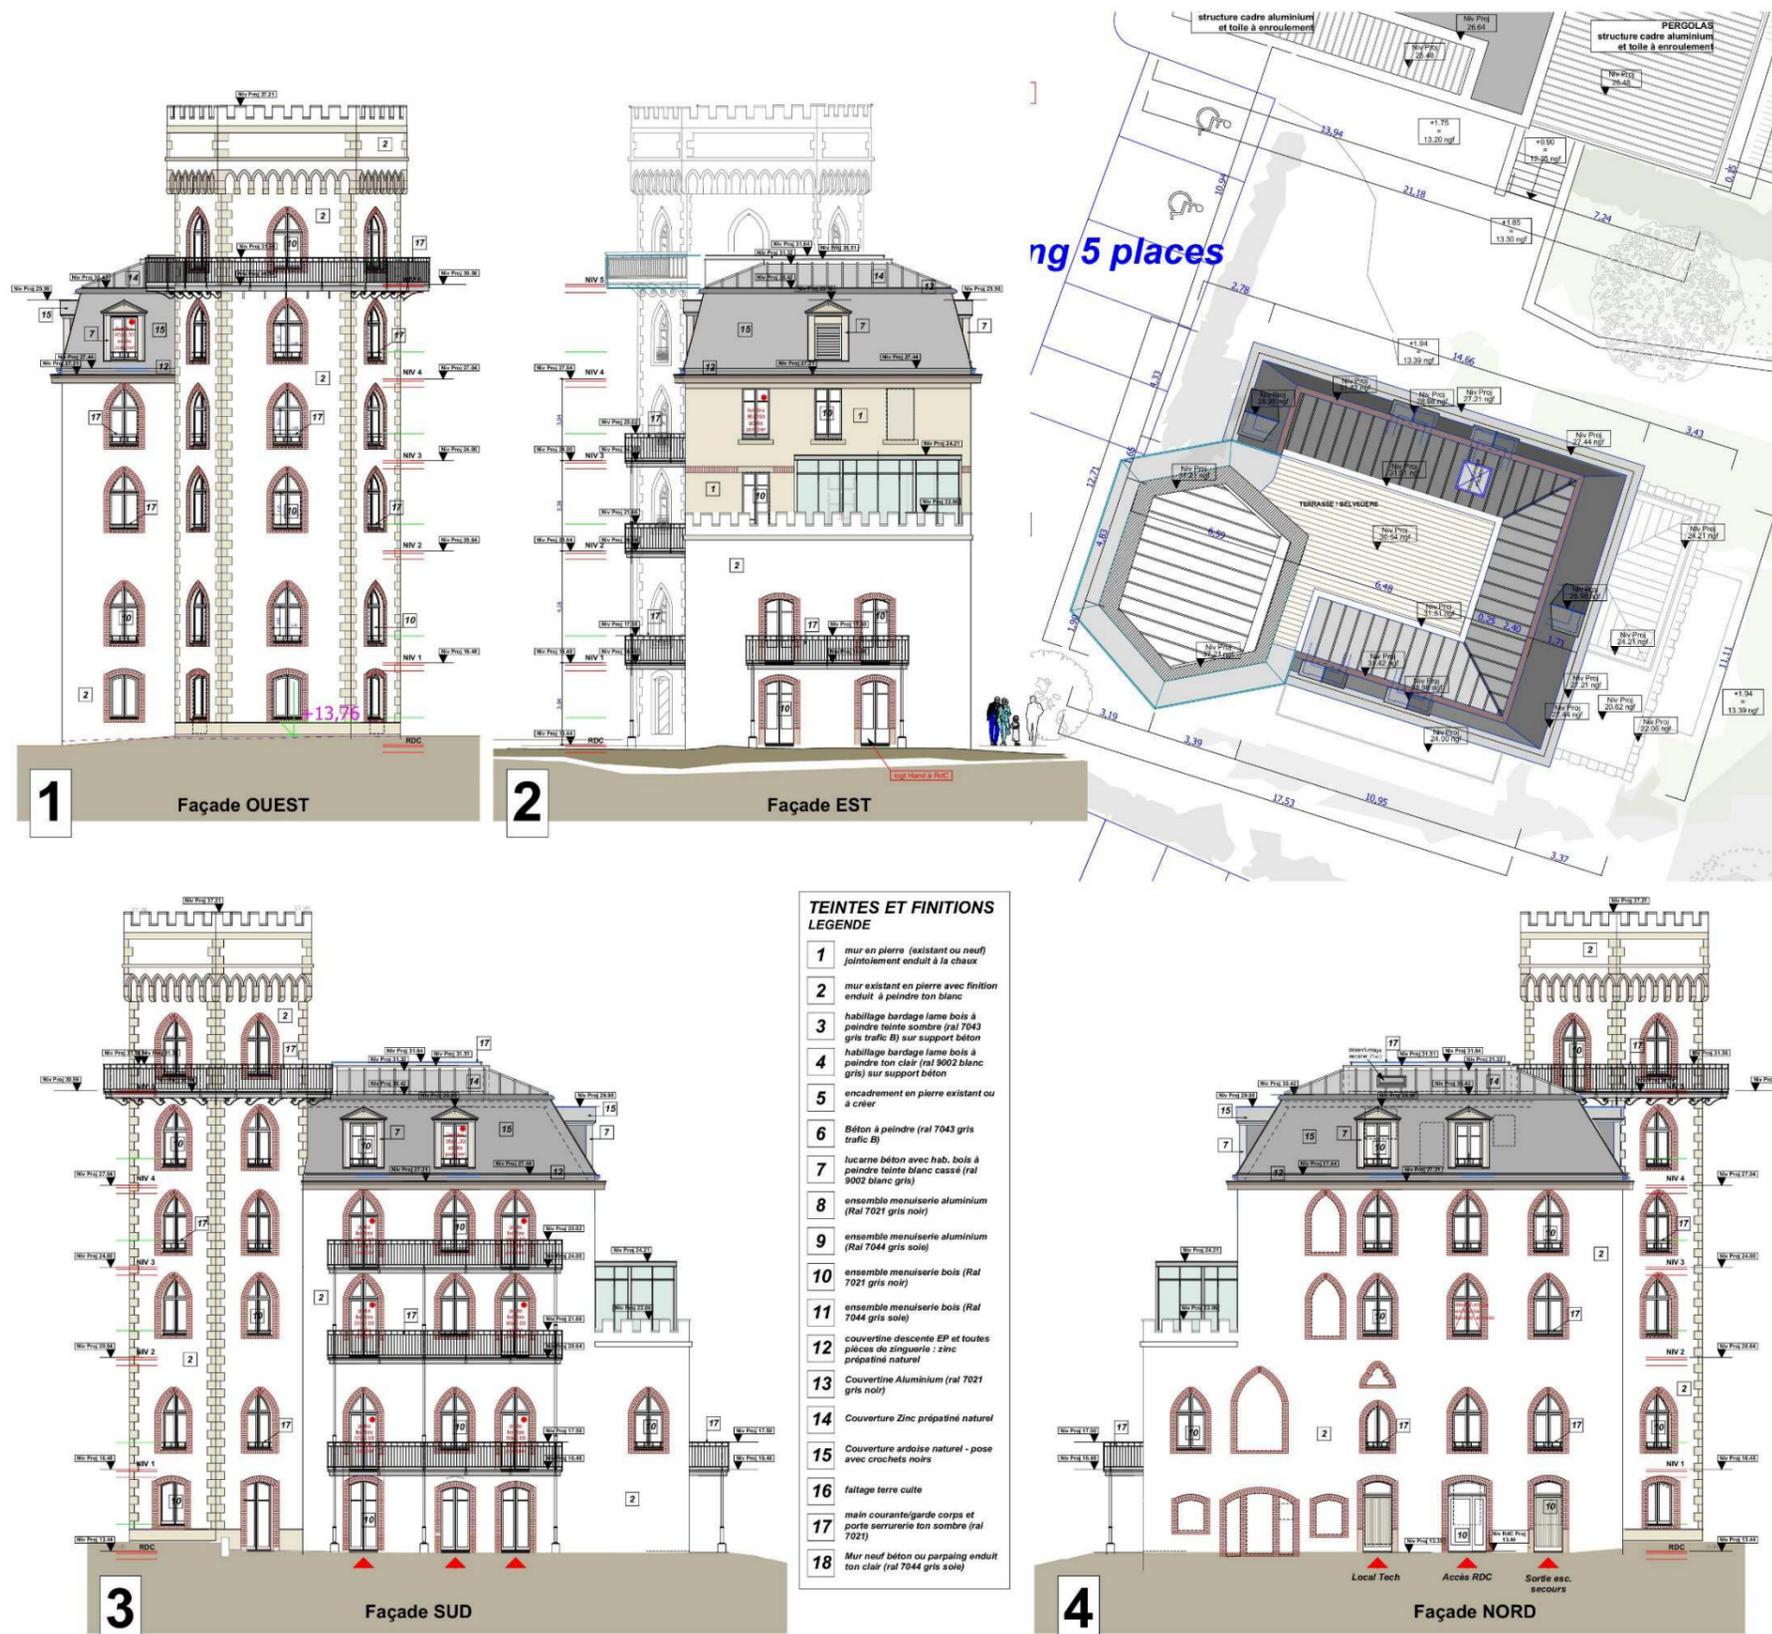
Plan masse de la Tour (Source : Paumier Architectes Associés)
